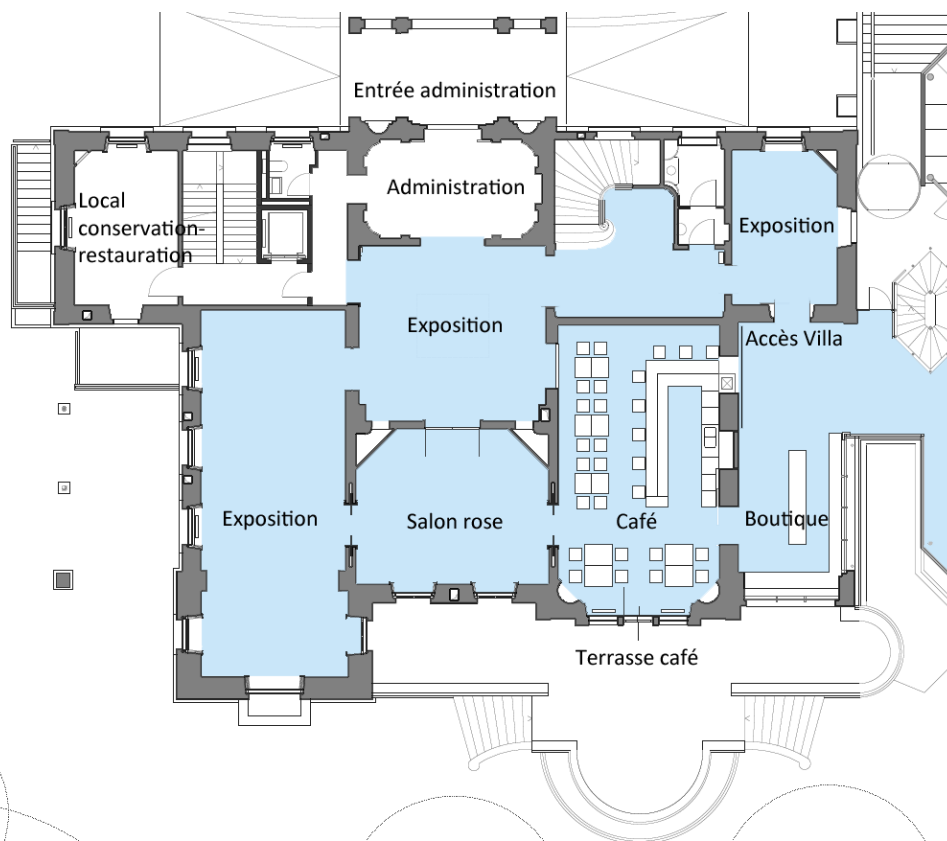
Plan du rez-de-chaussée de la Villa de Pury.
